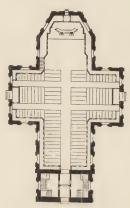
Hauptkirche zu Altona. Grundriss.
